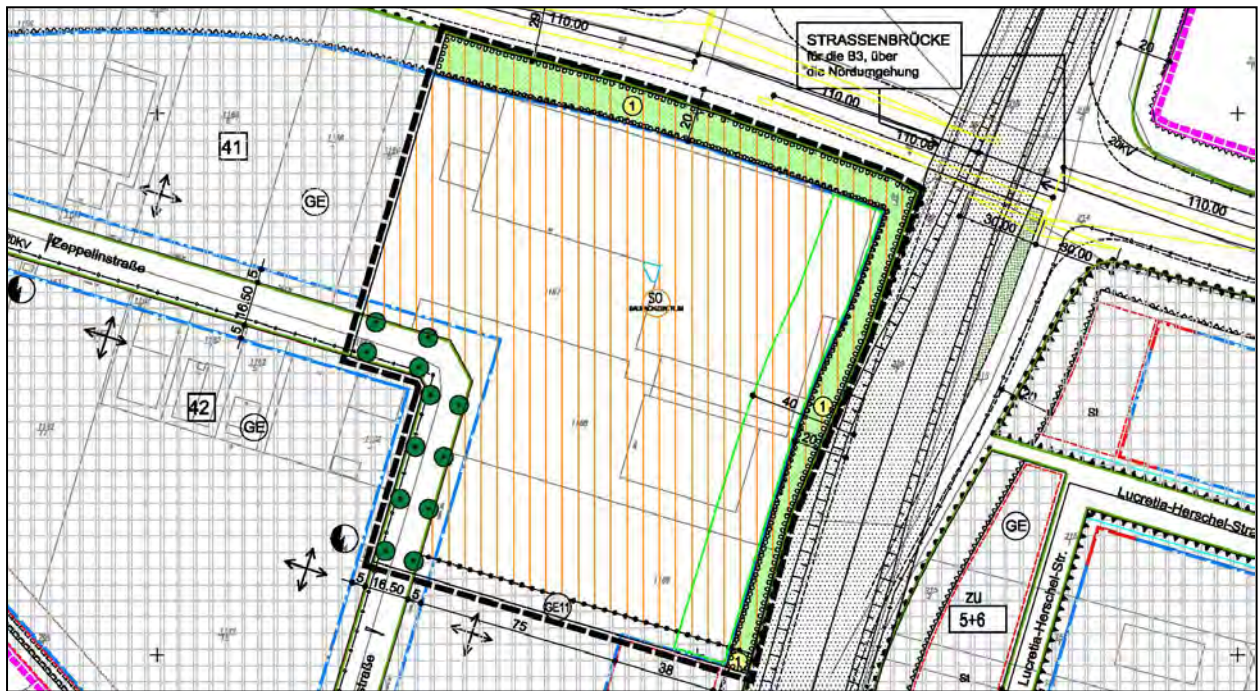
Bebauungsplan „5. Änderung Krebschere“
